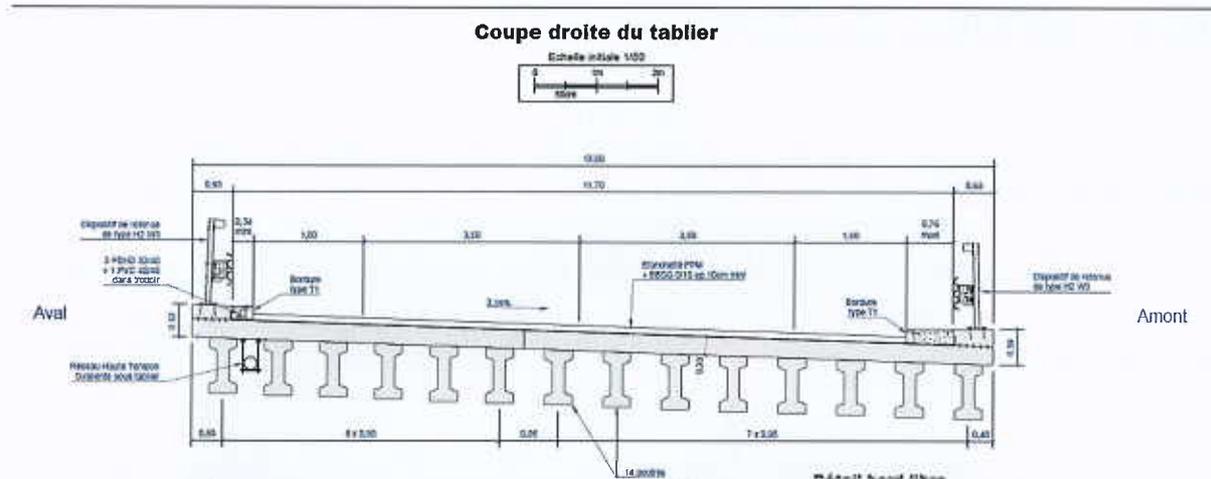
Profil en travers sur ouvrage, Études projet, Lombardi, 2023
